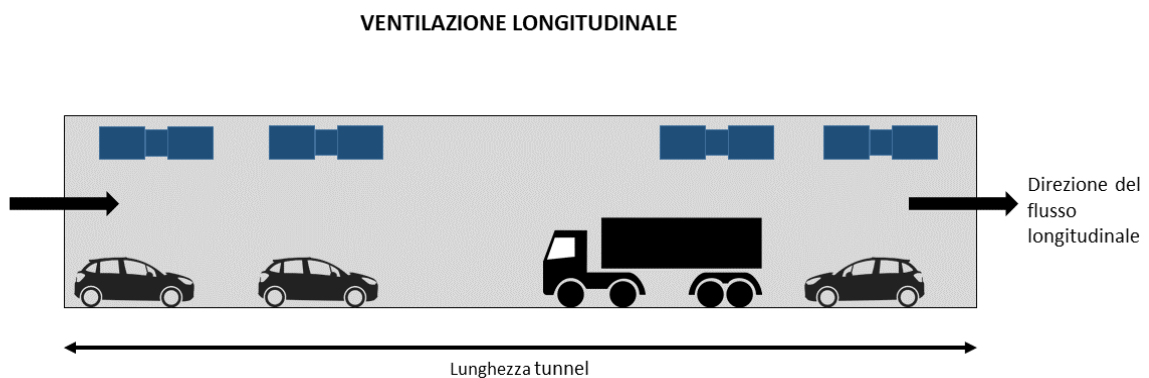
Schema di funzionamento della ventilazione longitudinale.
